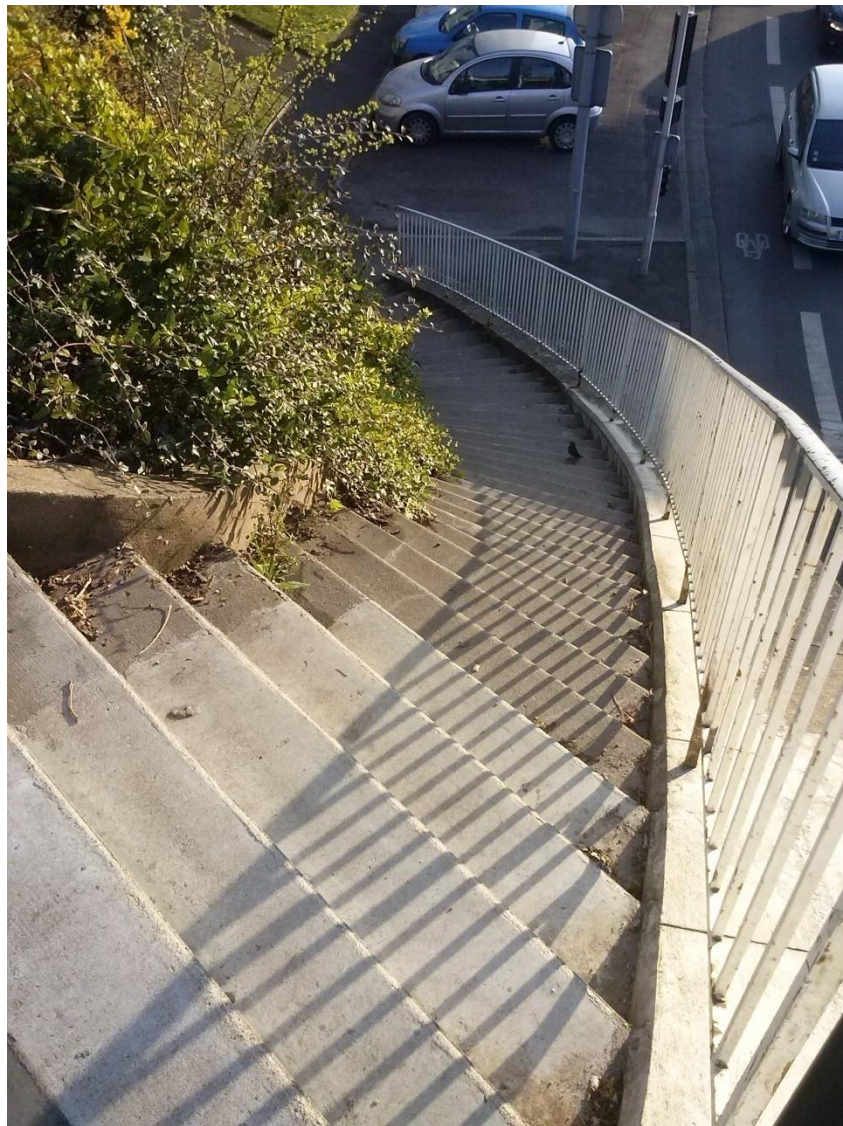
photo de l'escalier permettant d'accéder à la station Charcot (source : T.CHAMPIGNY)
